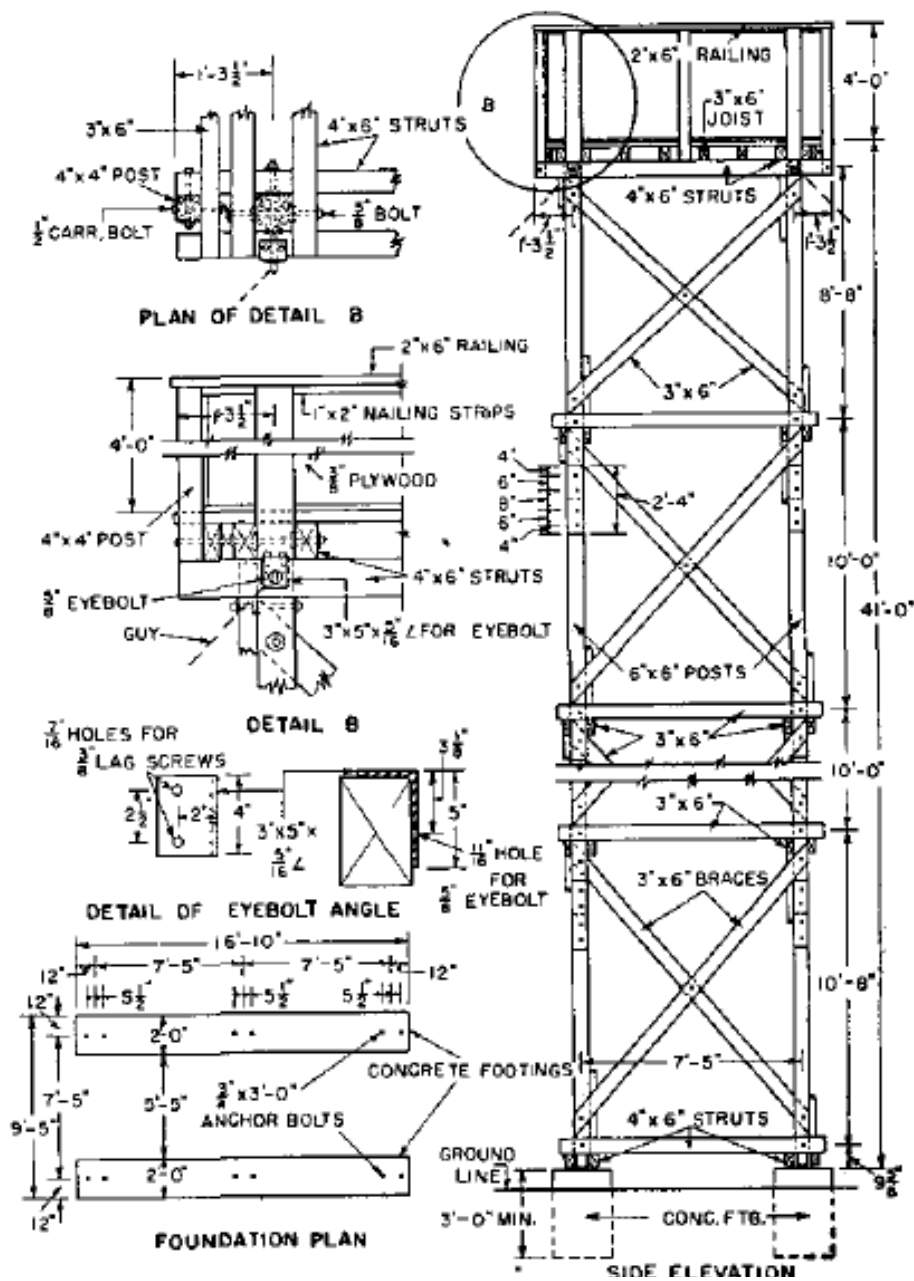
Protiletadlová věž – konstrukční detaily základů a platformy pro zbraň
